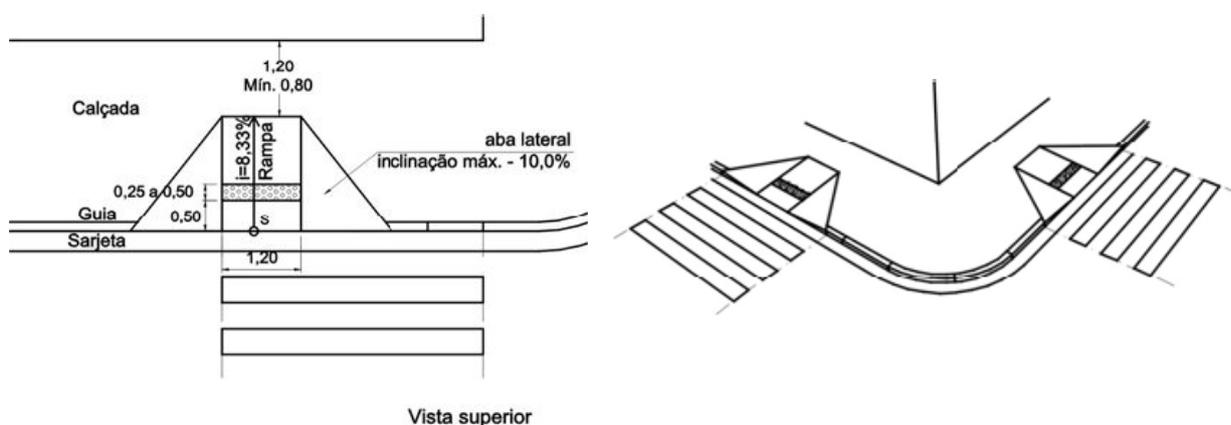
8 – Vista superior e perspectiva do rebaixamento da calçada.
